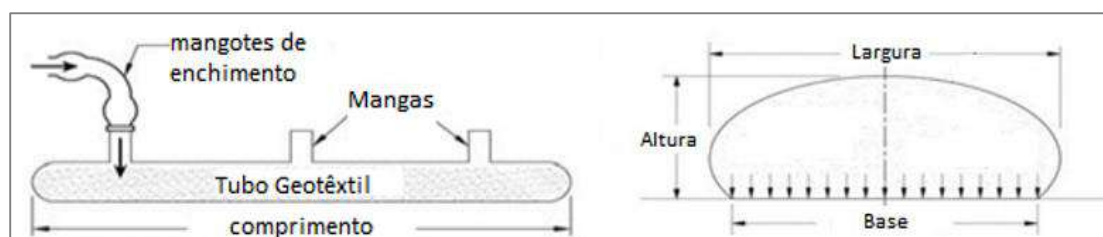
Perfil longitudinal e transversal típicos de um tubo geotêxtil (Lawson, 2008)
